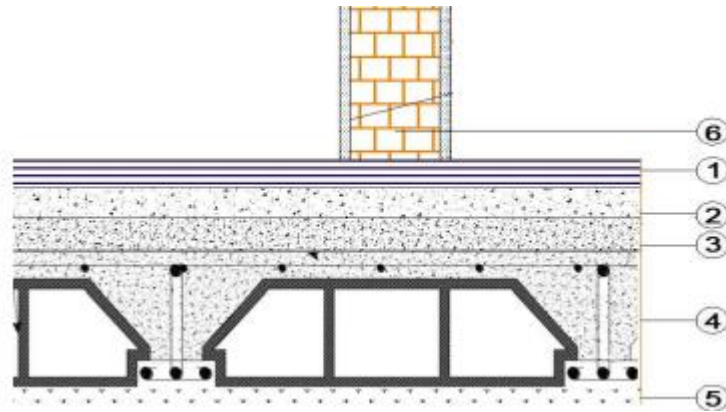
Coupe verticale d'un plancher d'étage courant.
